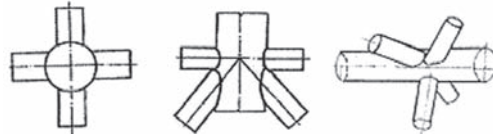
Типовые сборочные узлы металлоконструкций опорных блоков
